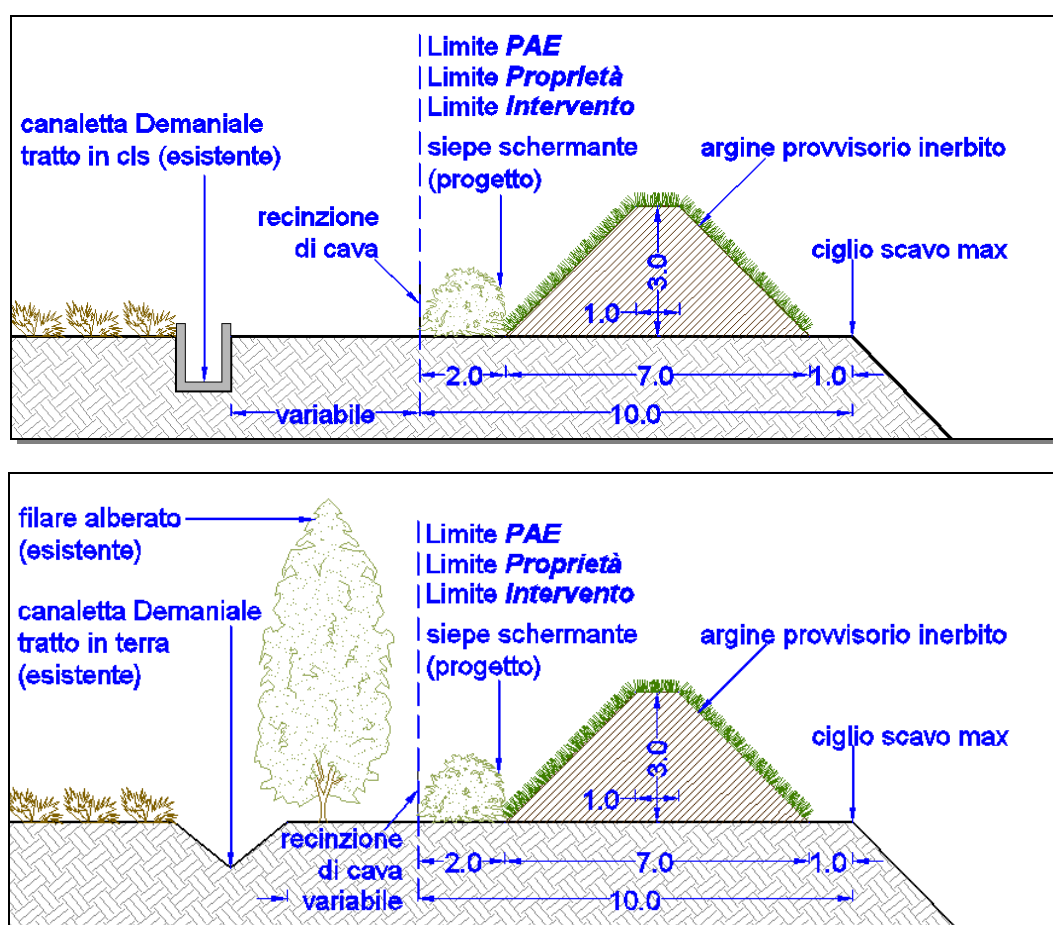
Arginatura perimetrale sul limite d'intervento ovest da porsi a mitigazione nei confronti di proprietà di terzi. (sopra) – limite ovest nel tratto sud in affaccio al manufatto idraulico. (sotto) – limite ovest nel tratto nord in affaccio al canale irriguo con fondo inciso in terra contornato dal filare di pioppi.
